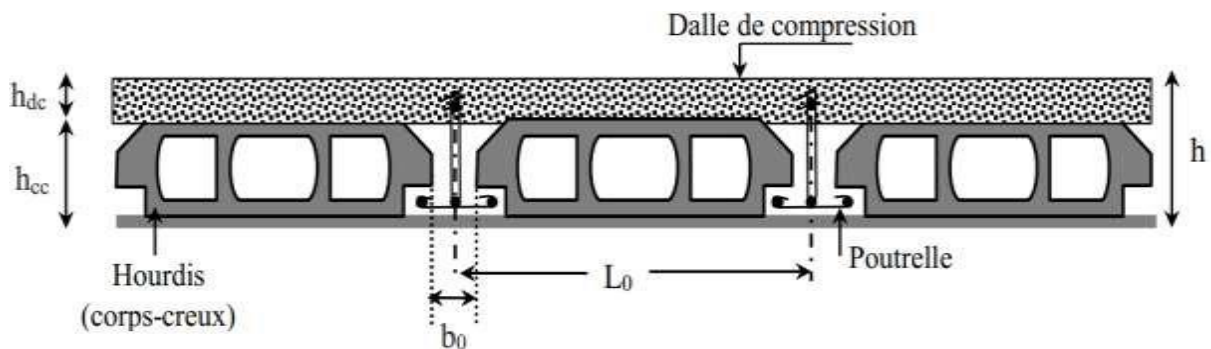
Coupe transversale d'un plancher à corps creux
